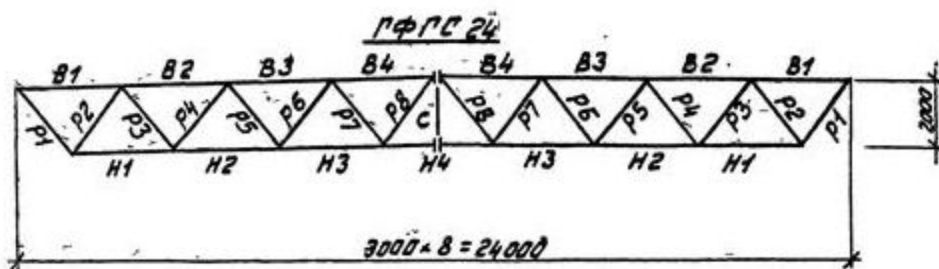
Геометрична схема ферми із серії 1.263.2-4
